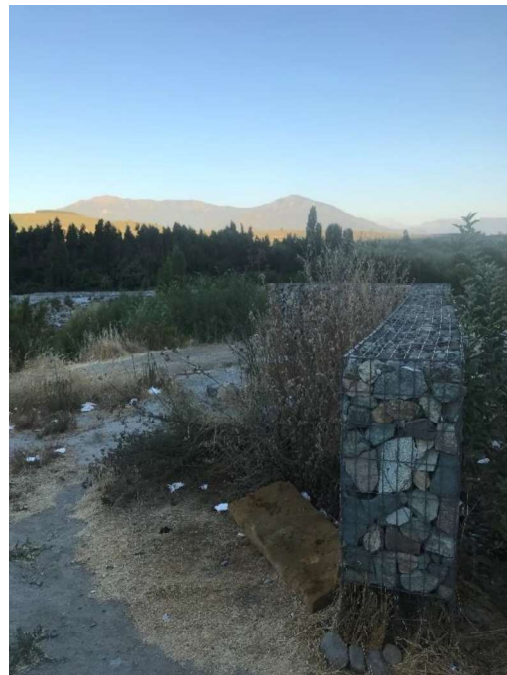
Malha metálica rígida elevando o conteúdo de pedra do solo
